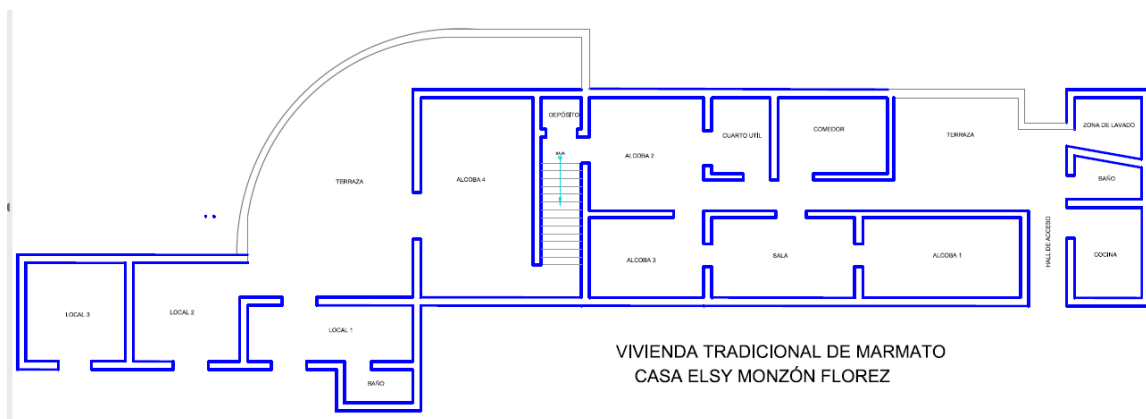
Planta Arquitectónica: Vivienda tradicional Marmato. Elaboración Propia
